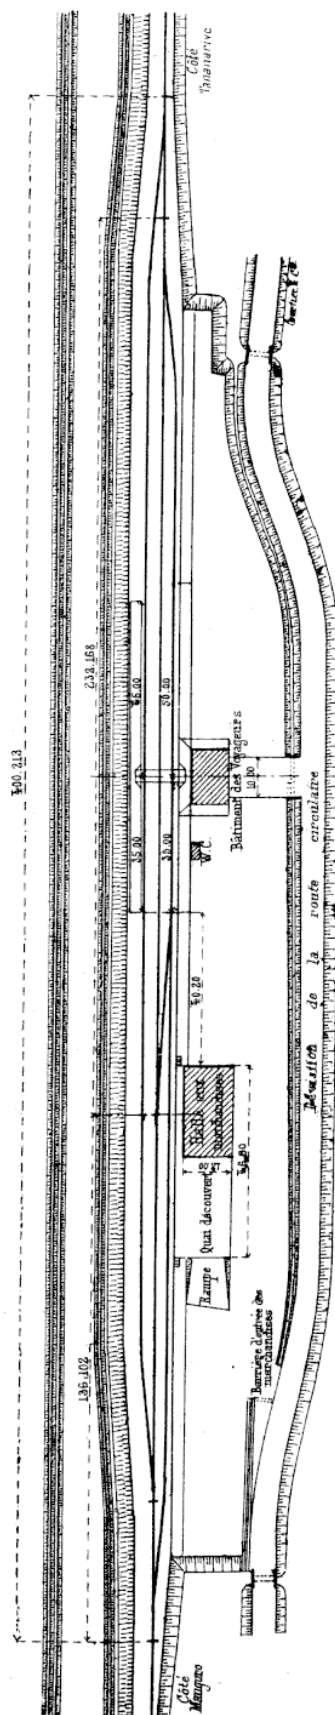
PLAN DE LA GARE D'ANTWERANO.
